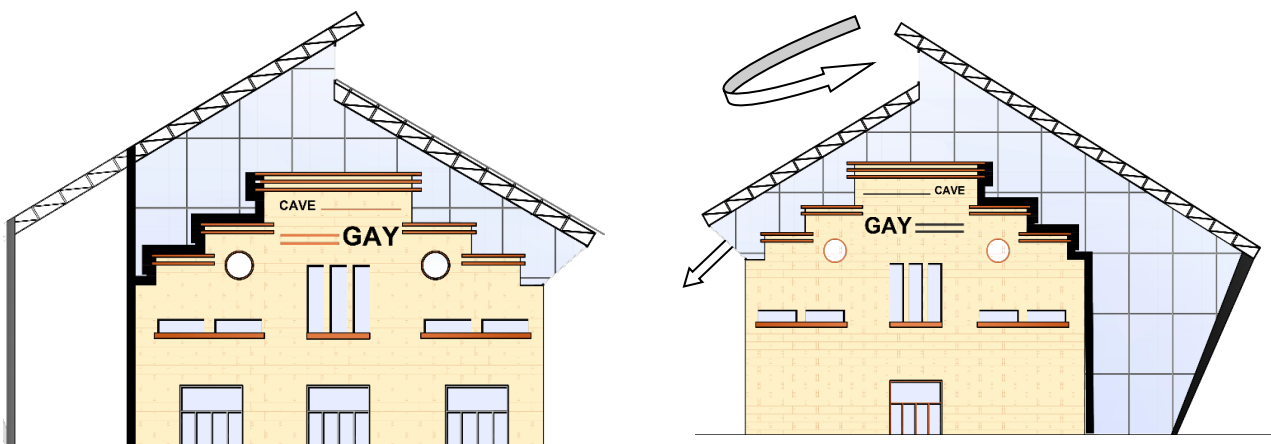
FAÇADE CAVE GAY AVEC LA TOITURE SOURCE AUTEUR 2022
